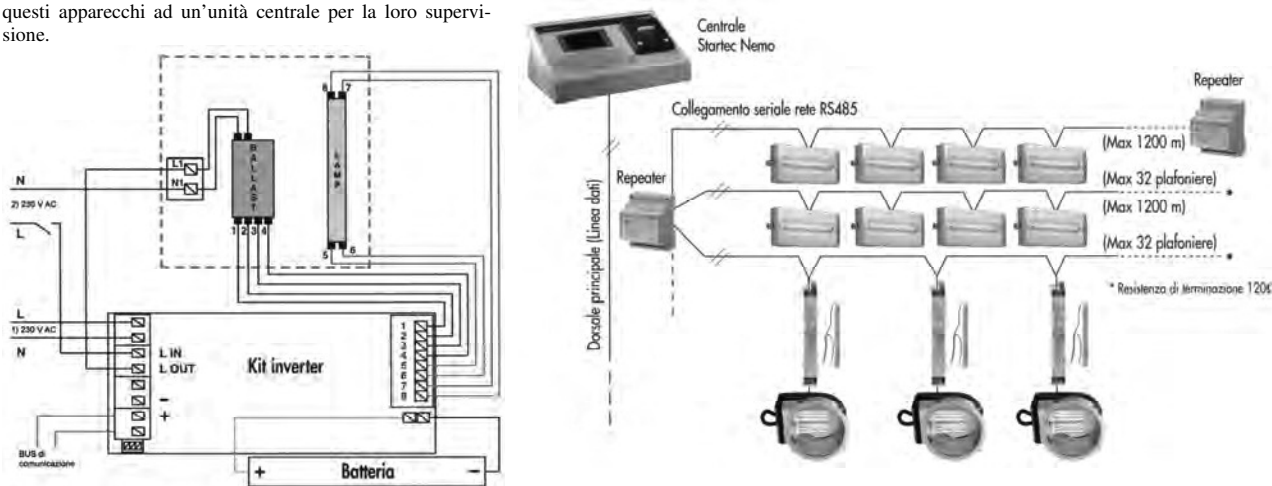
Schema elettrico di un kit per illuminazione di emergenza. Lo schema, (simile a quello inserito anche nelle plafoniere autonome con lampade fluorescente tipo fig. 4.167a), consente l'alimentazione di una plafoniera dotata di lampada fluorescente alimentata mediante trasformatore elettronico (Gewiss).
